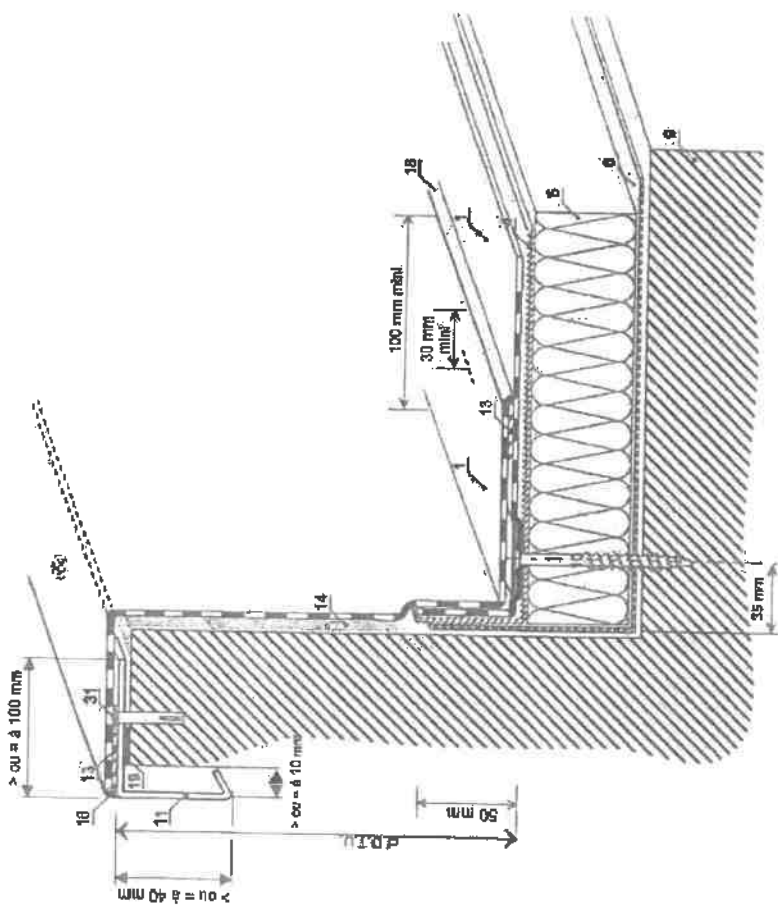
Relevé d'étanchéité - Coupe de principe sur béton travaux neufs
